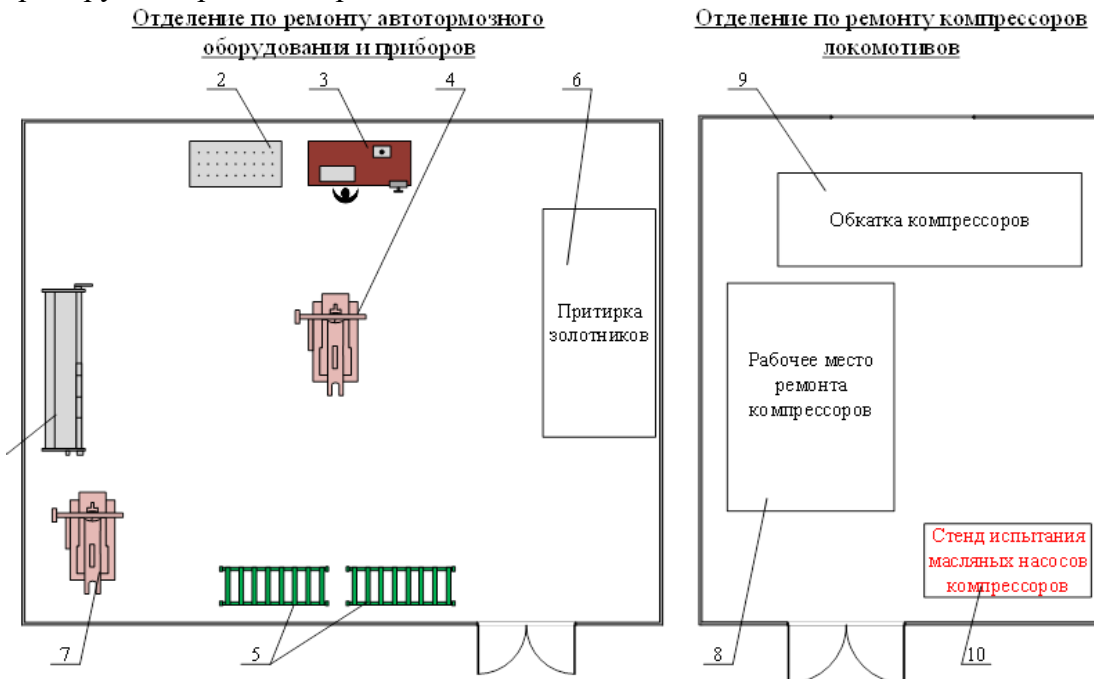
Существующий план автоматного цеха: 1 – стенд проверки автотормозного оборудования; 2 – рабочее место для ремонта кранов машиниста; 3 – верстак для ремонта кранов, клапанов и фильтров; 4 – стенд для испытания соединительных рукавов; 5 – стеллаж готовой продукции; 6 – станок для притирки золотников кранов машиниста; 7 – Стенд проверки крана вспомогательного тормоза №215; 8 – рабочее место ремонта компрессоров; 9 – стенд для обкатки компрессоров; 10 – стенд для испытания масляных насосов компрессоров
